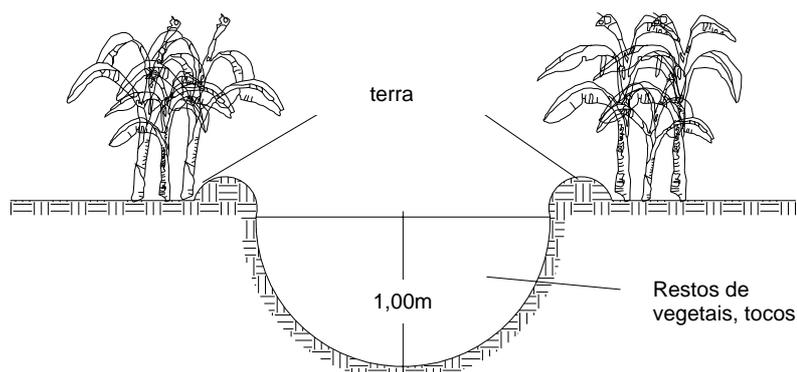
Perfil do círculo de bananeiras. Dimensões em metros (m).
